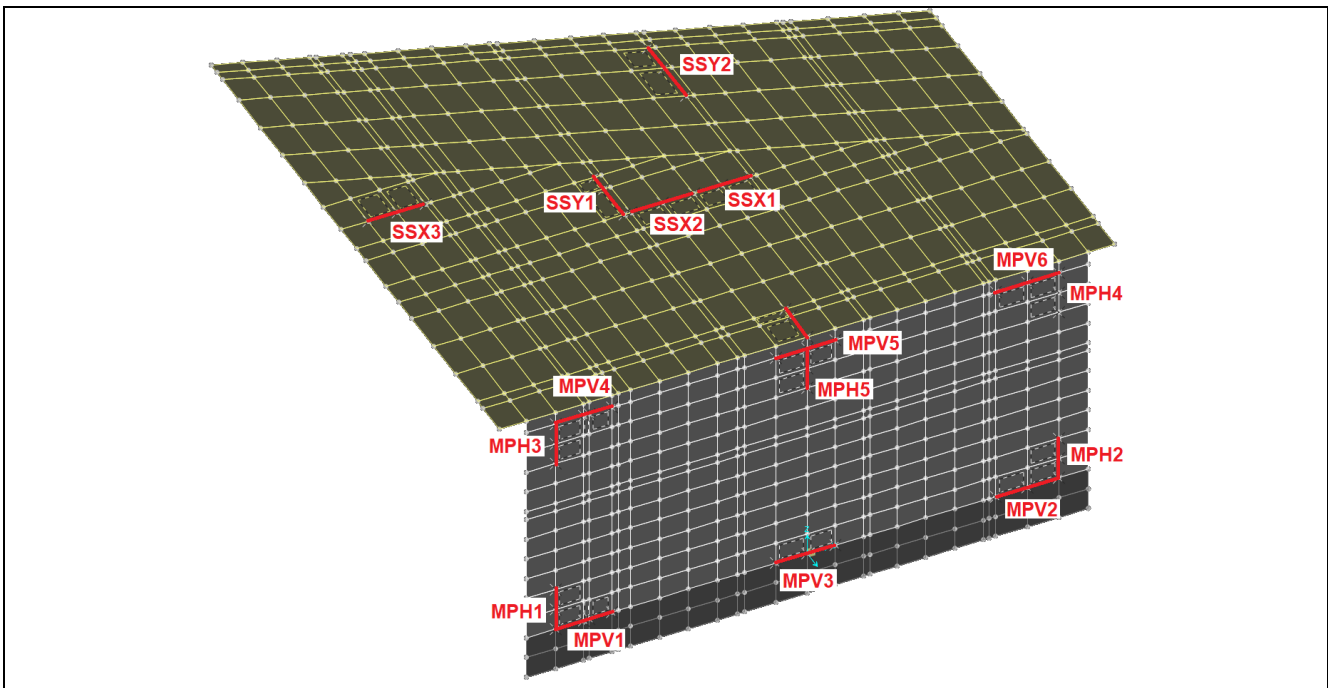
Sezioni di verifica della spalla - muro posteriore e soletta superiore
